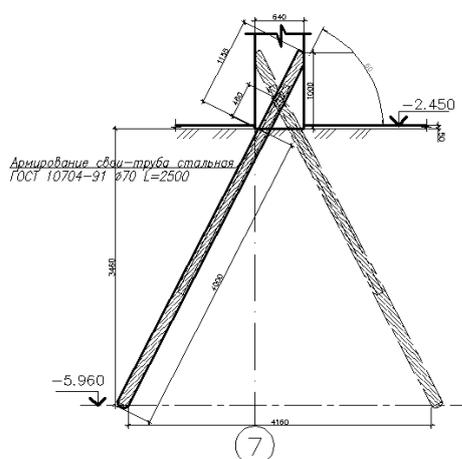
Схема усиления фундамента наклонными буронабивными сваями
